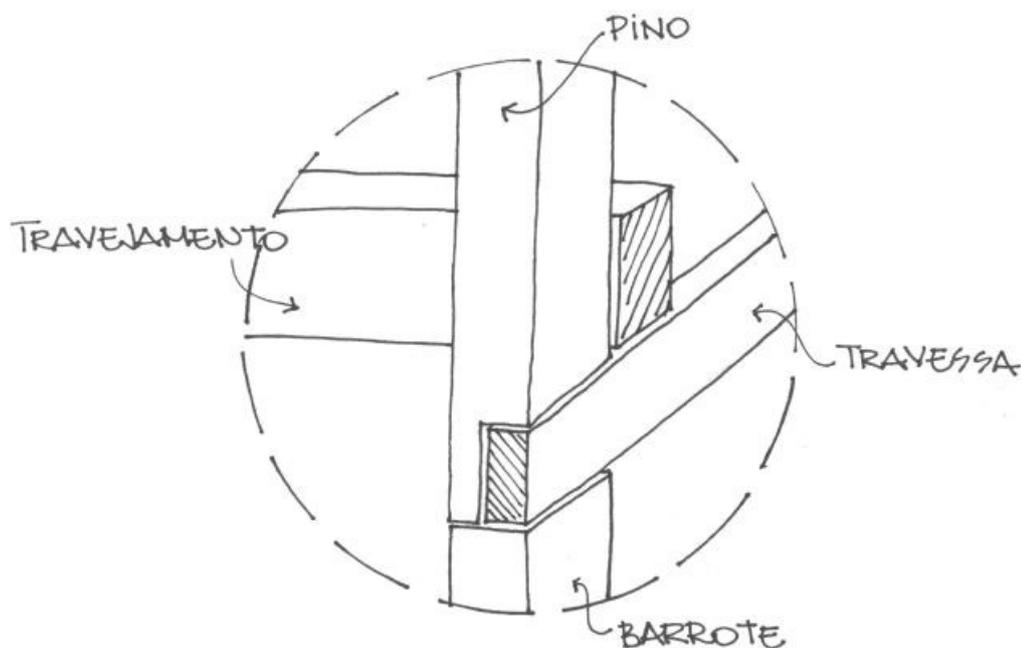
Desenho esquemático da estrutura de apoio da casa
